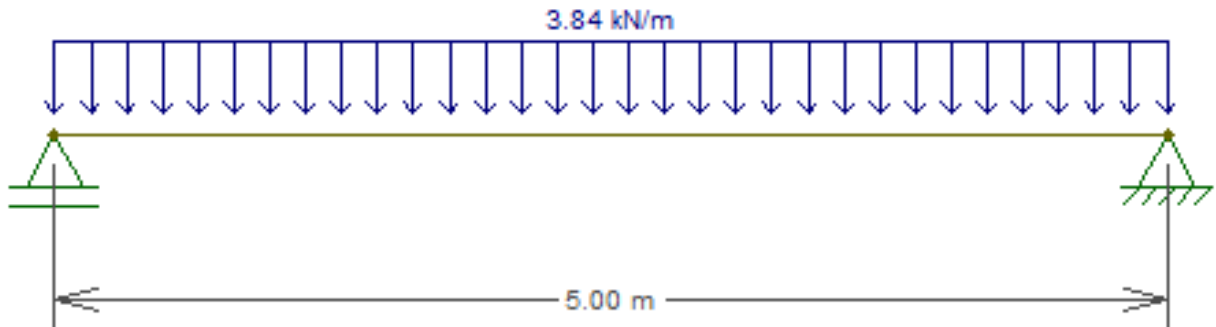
Distribuição de carga da laje em uma viga biapoiada gerada pelo Ftool
